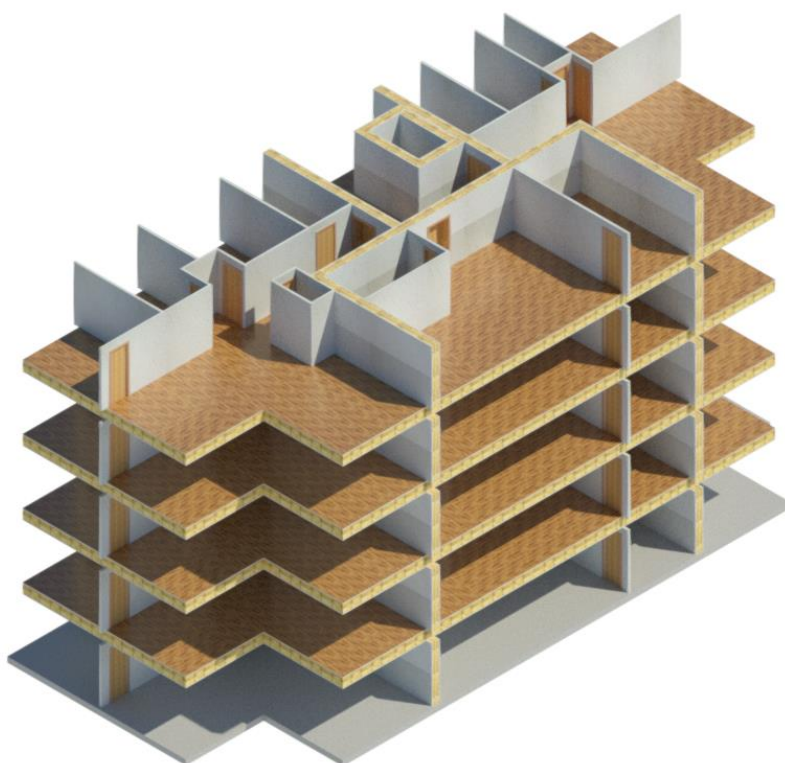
Ritning av ett plan som blivit omstrukturerad i Revit.
